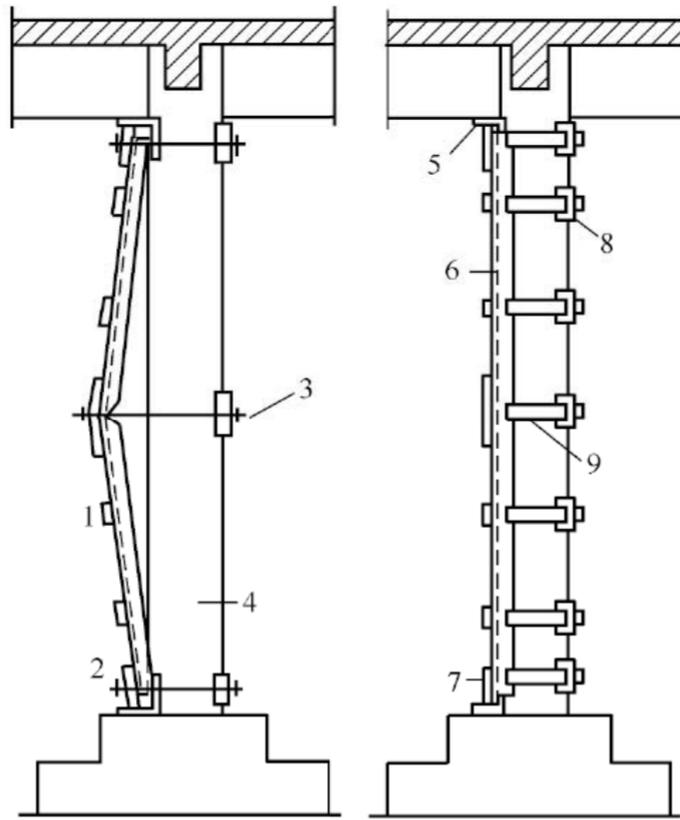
钢筋混凝土柱双侧预应力加固撑杆构造
